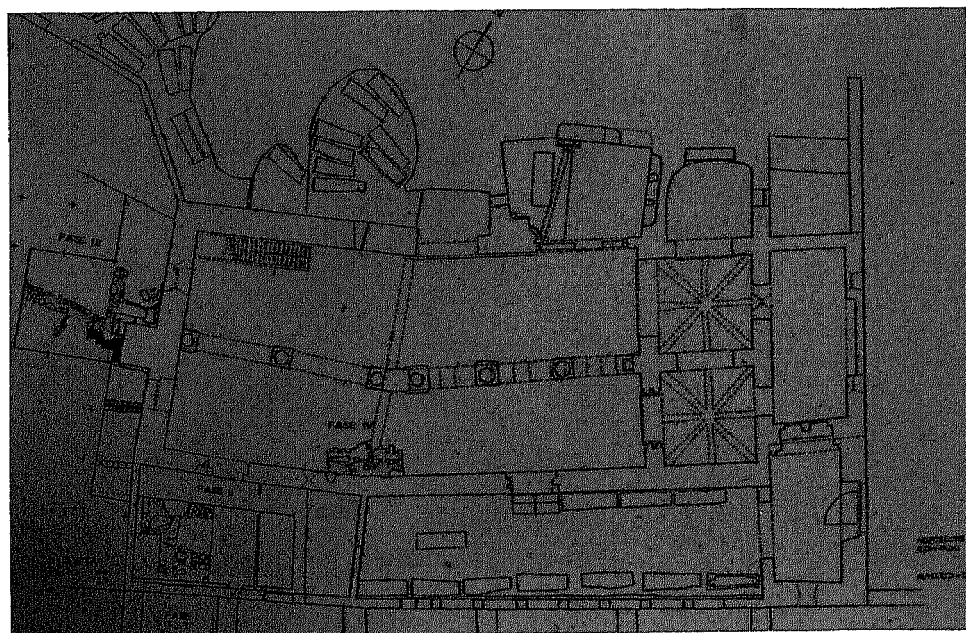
Plano general de las excavaciones arqueológicas. Fase I: apeos. Fase II: estancia sudoeste. Fase III: exterior del templo en el flanco oeste. Fase IV: cata en el interior de la iglesia.
